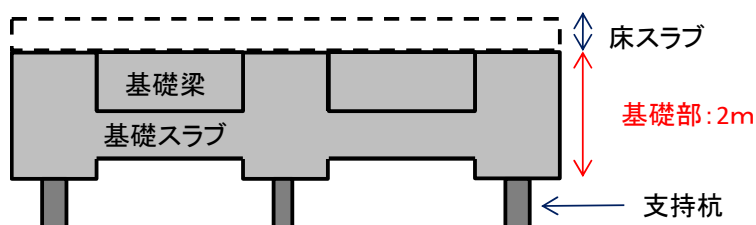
固体廃棄物貯蔵庫第 9 棟の断面図から想定した基礎部断面図
